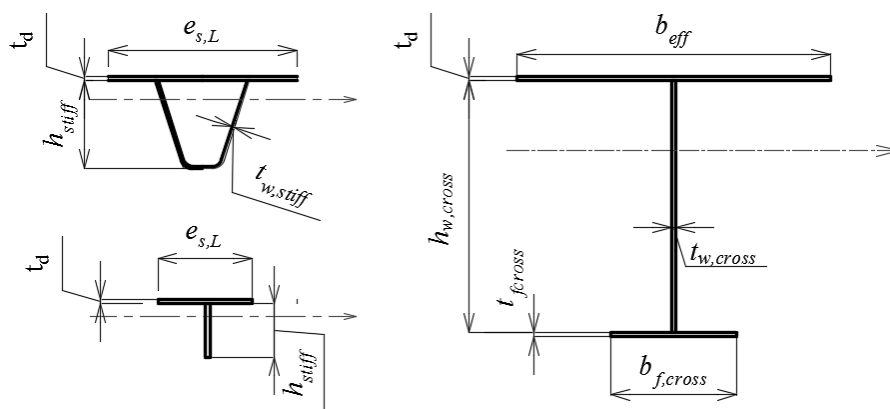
Перерізи поздовжніх ребер і поперечних балок. Познаки
